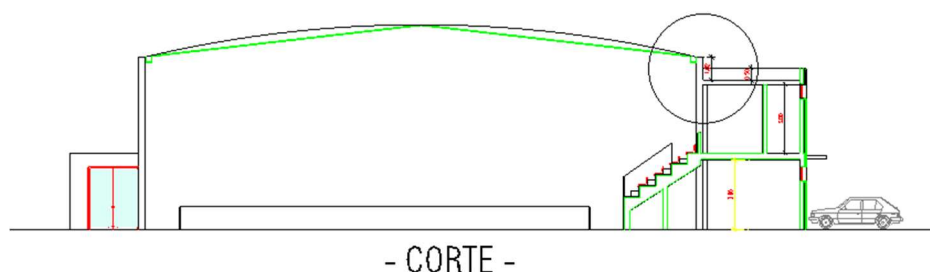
Corte transversal do pavilhão gimnodesportivo
